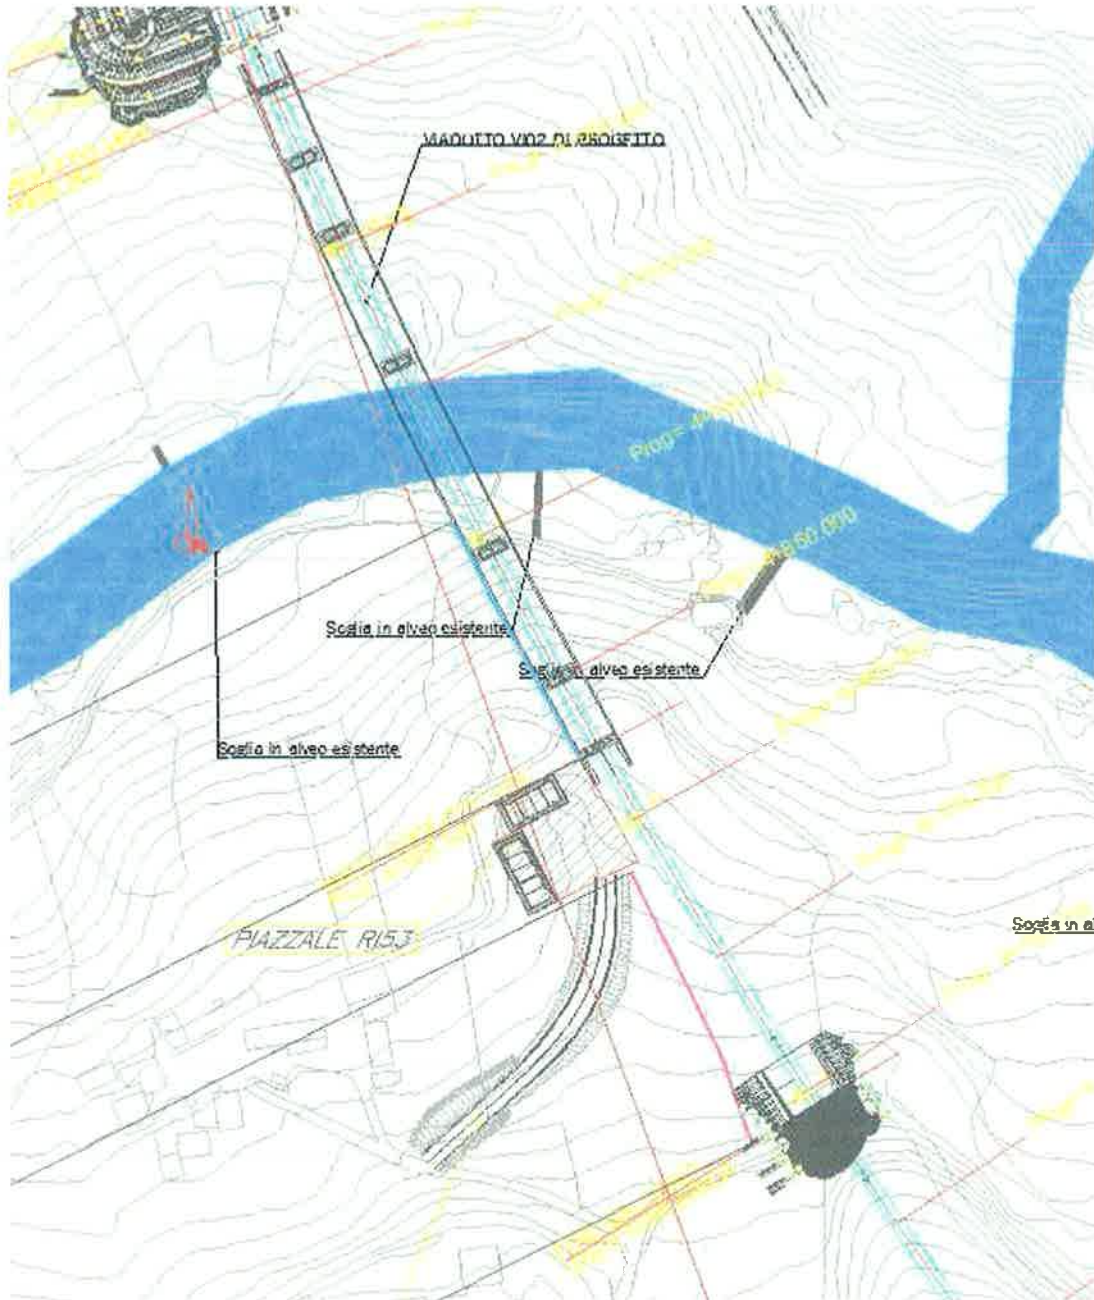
Viadotto VI02 di progetto. Planimetria.
